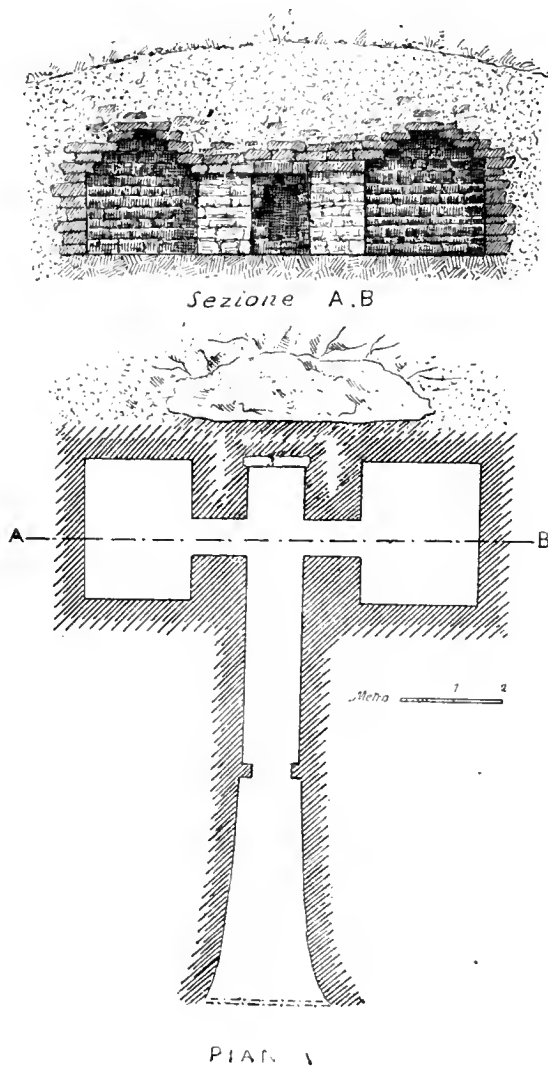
Pianta e sezione dell'ipogeo orientale.
